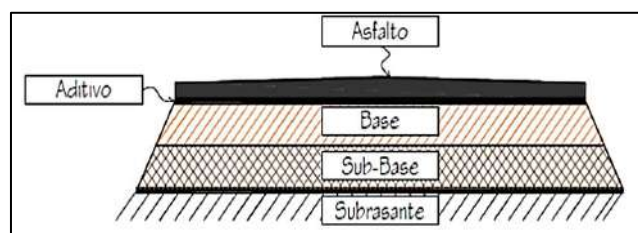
Sección transversal típica de pavimento semiflexible o semirrígido Armijos [42]
